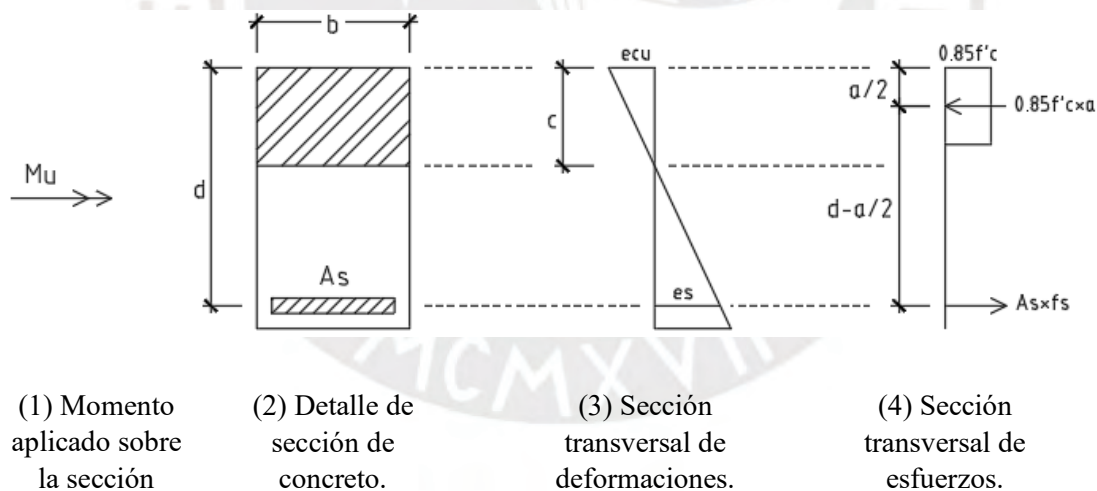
Detalle de sección de concreto armado sometida a flexión pura.
